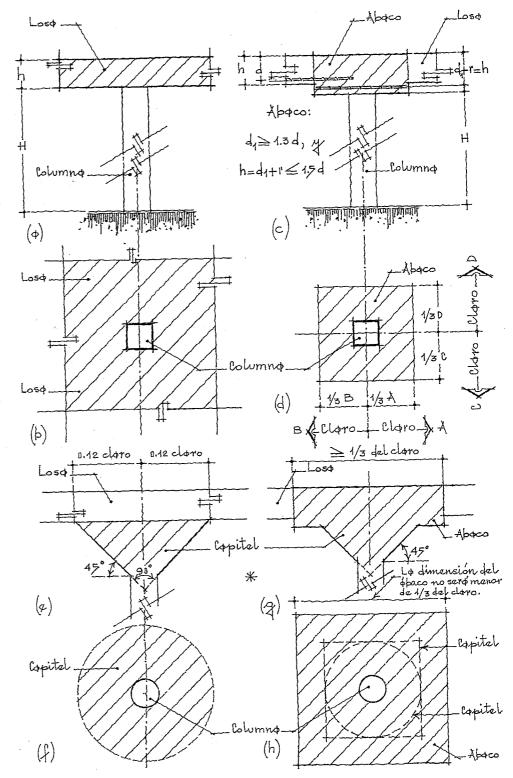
Loso apoyado directamente sobrelo columno, (0). Fig. 16.14. Plonto, (b).
